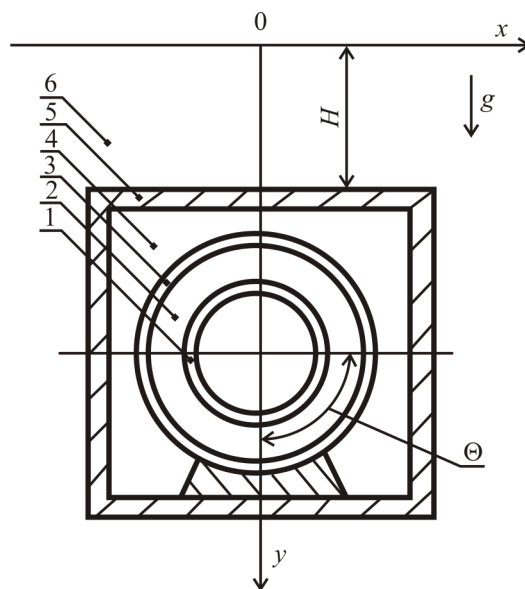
Схема области решения: 1) металлическая стенка трубы; 2) слой тепловой изоляции; 3) покровный слой; 4) полость канала; 5) железобетонная стенка канала; 6) грунт
